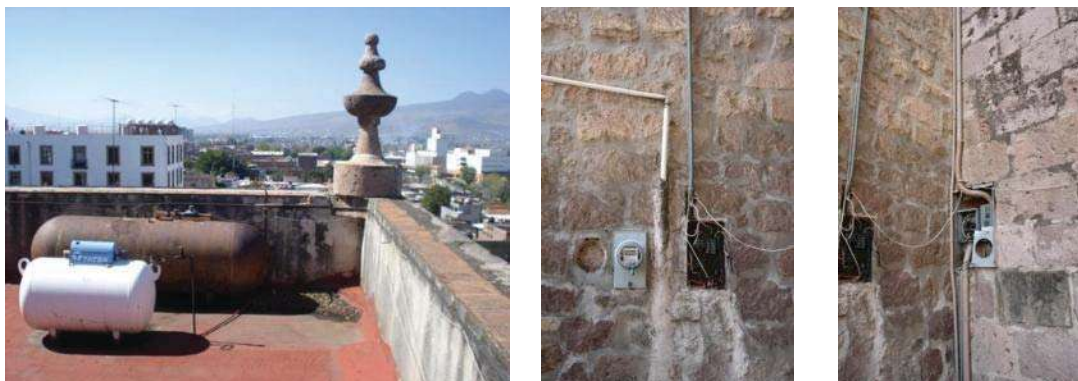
,93, 94. Instalaciones existentes, foto Yadira C. Avila Naranjo
